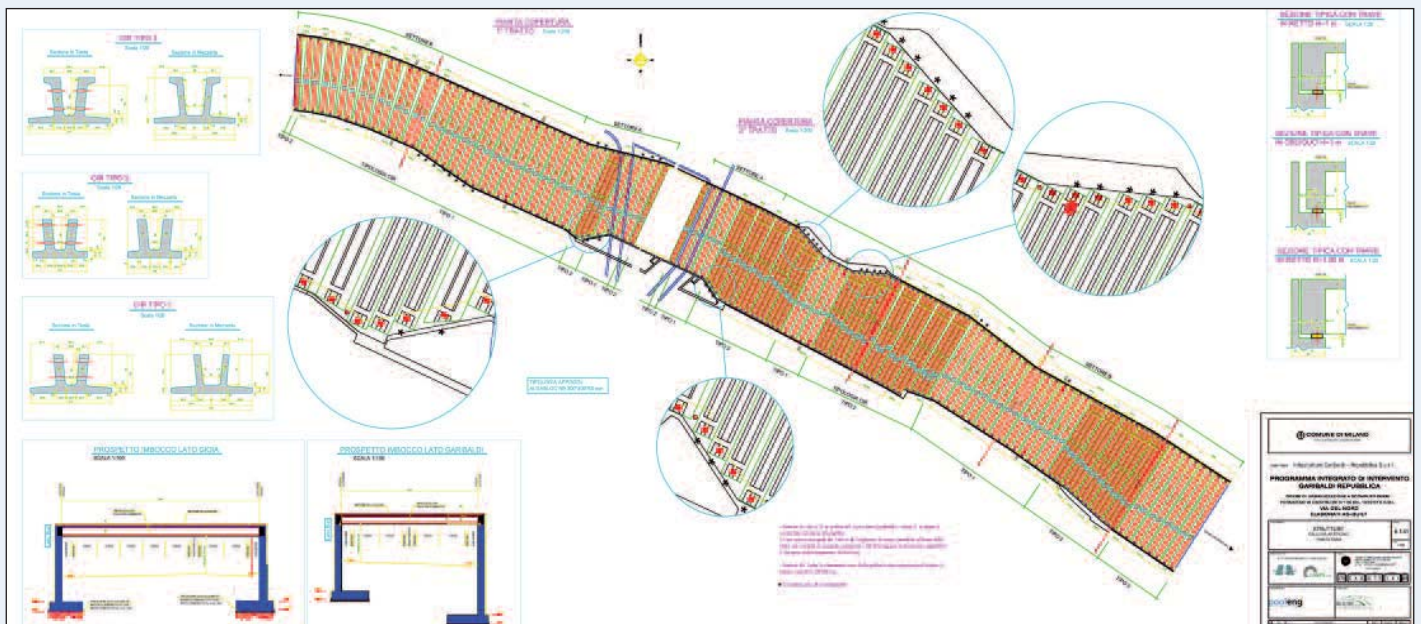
Lo schema di copertura del tunnel con 127 travi di cemento armato precompresso
